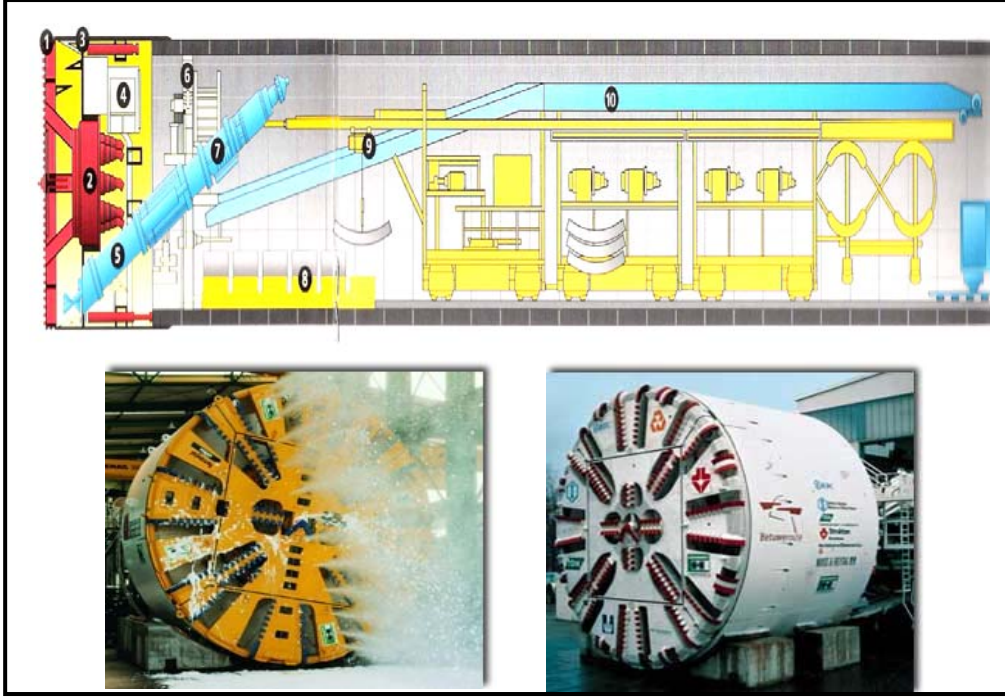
Çift kalkanlı (double shield) tünel delme makinesi
